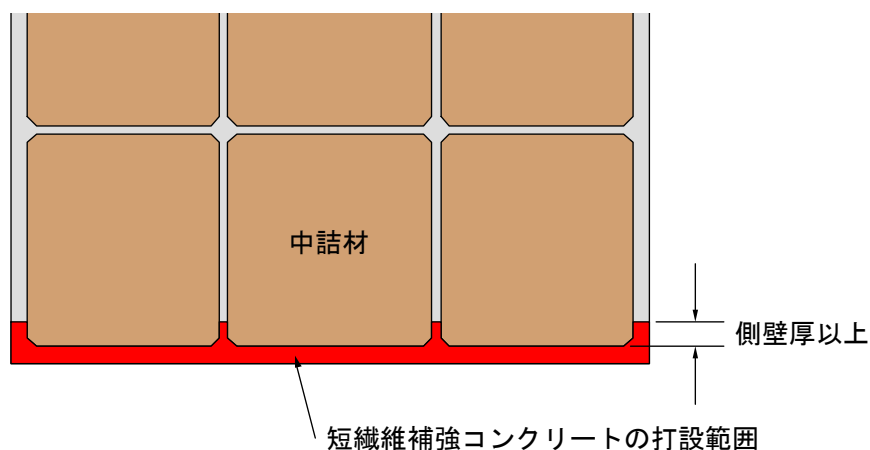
短繊維補強コンクリートの打設範囲のイメージ（平面図）
